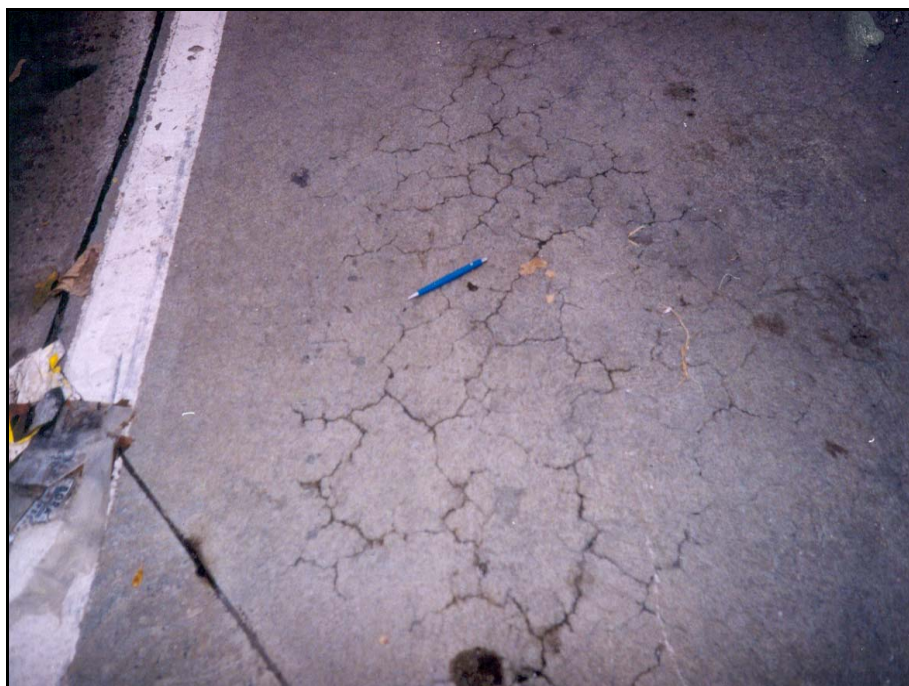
Fissuras em pavimento de concreto por deficiência de cura
